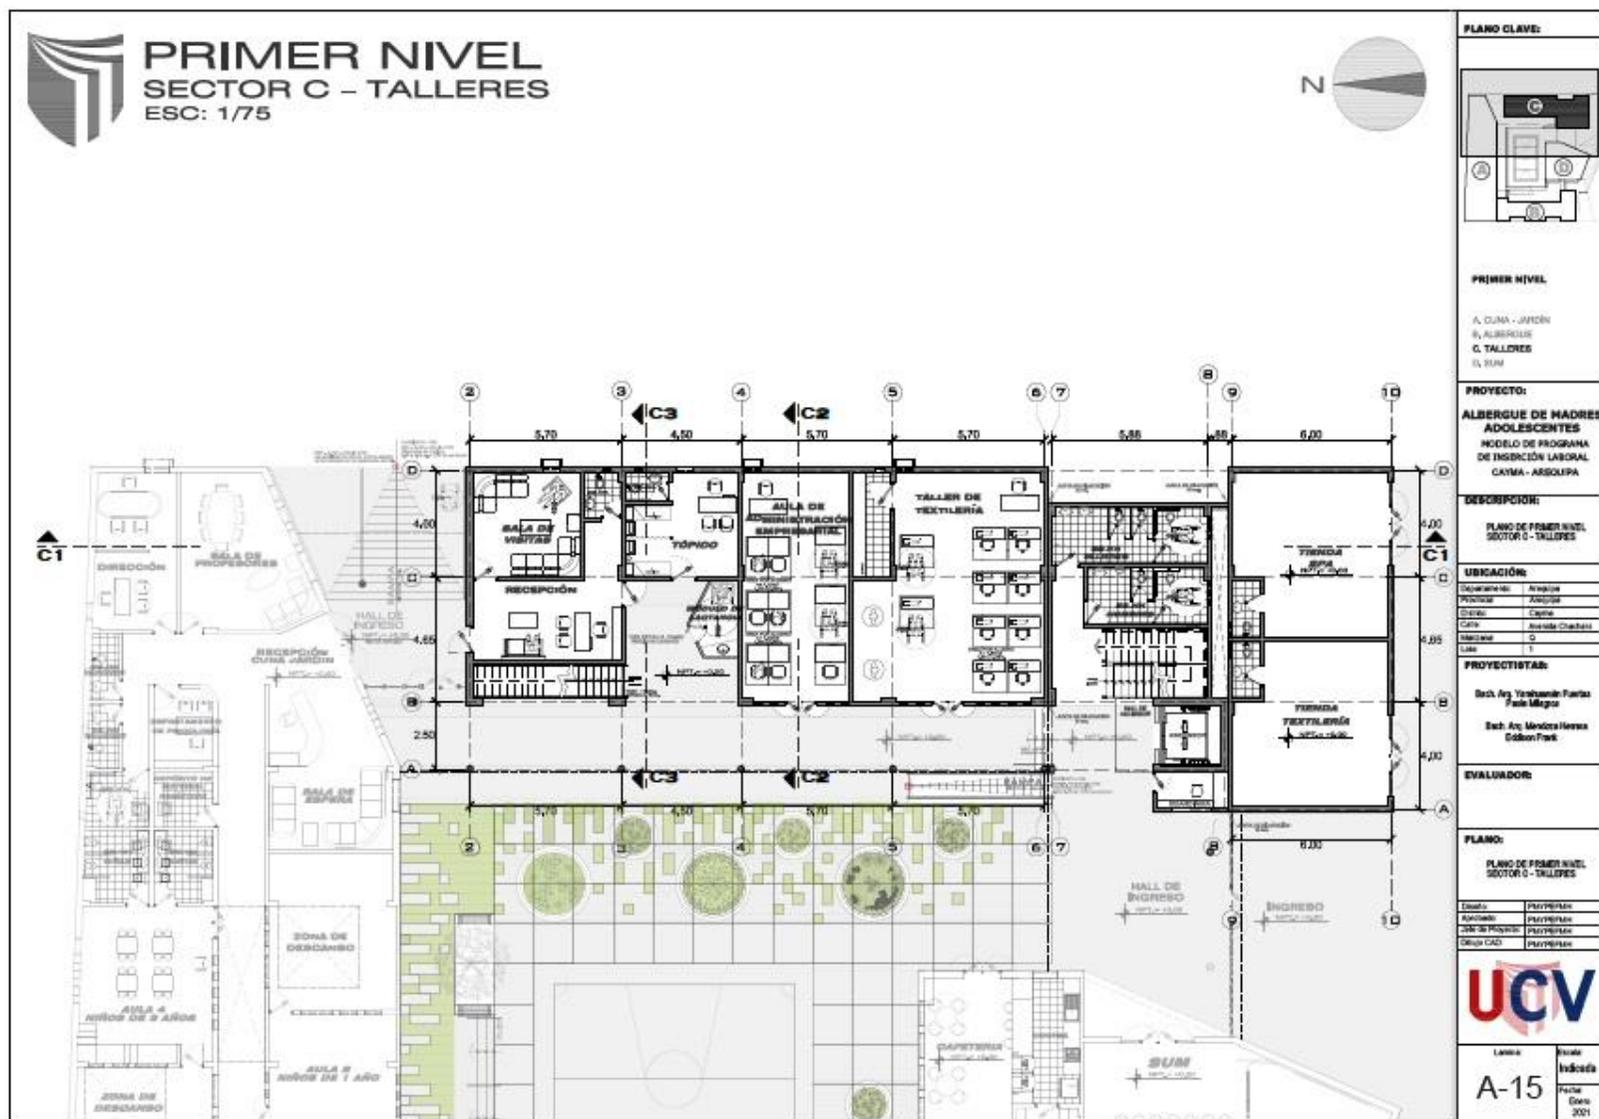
Plano de Sector C – Talleres – Primer Nivel A-15.
